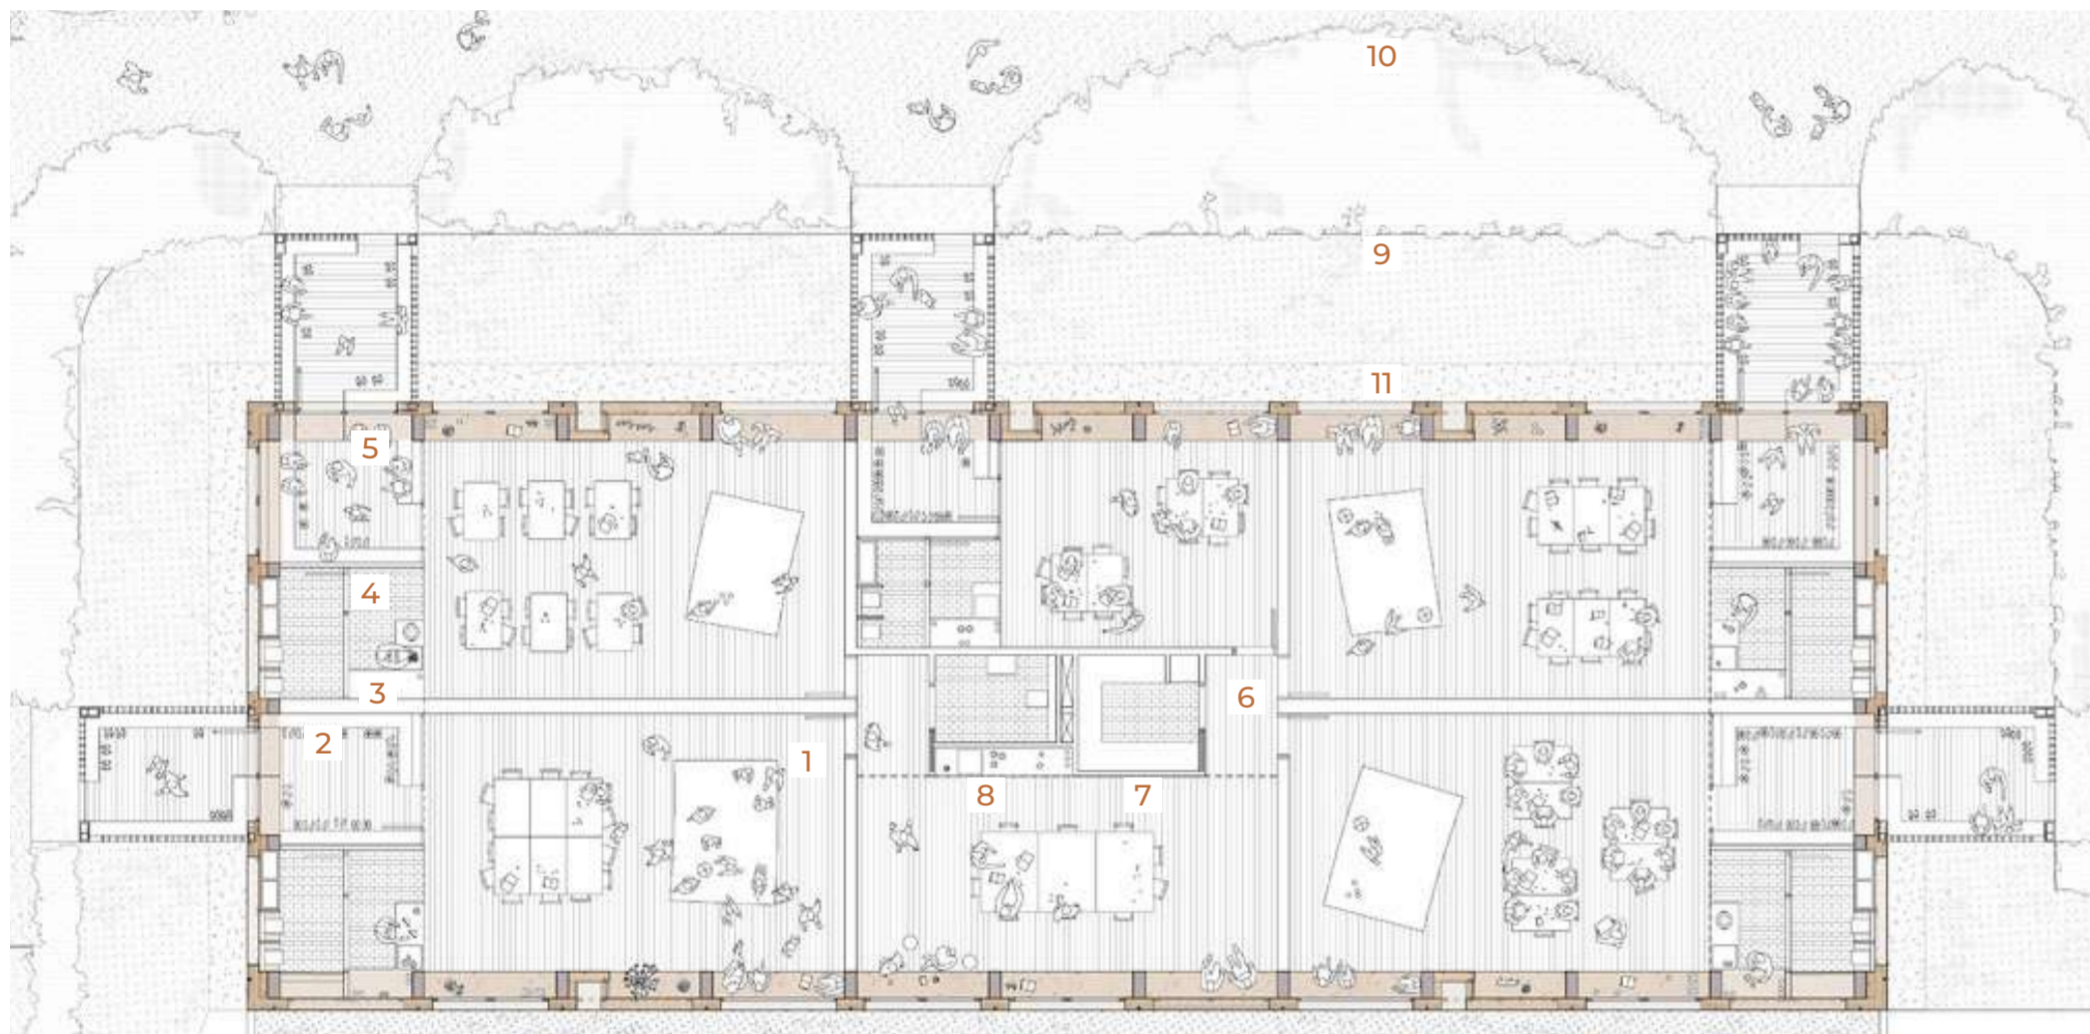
Escola El tiel-ler, planta baixa do 1º pavimento
